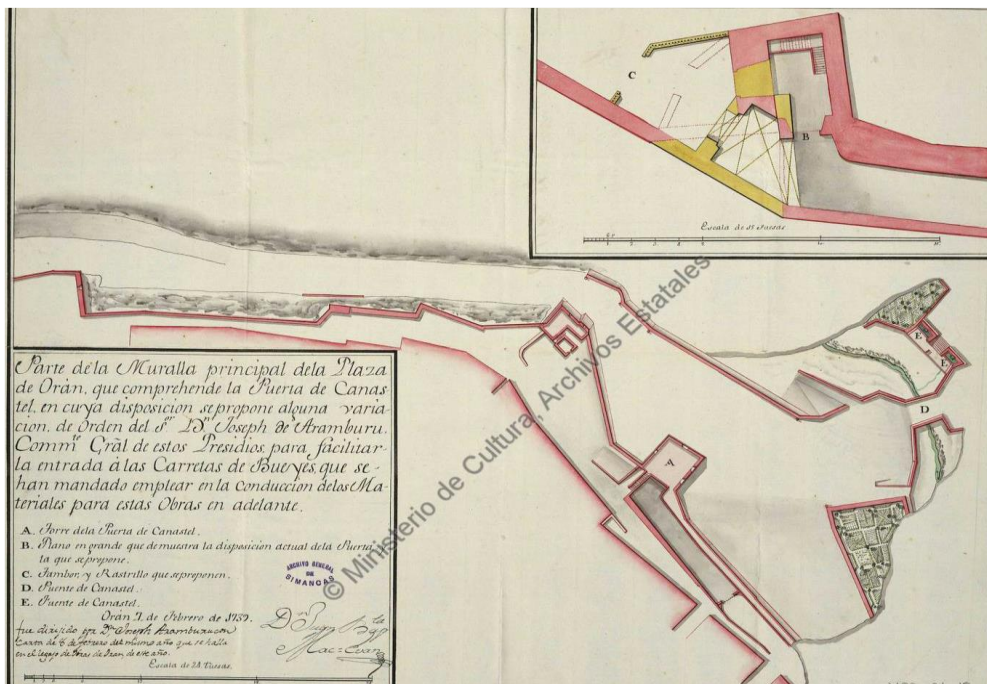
Plano de la puerta de Canastel con su tambor, rastrillo, puente de Canastel y la Fuente. (El plano está firmado por el ingeniero Don Juan Bautista MacEvan).
